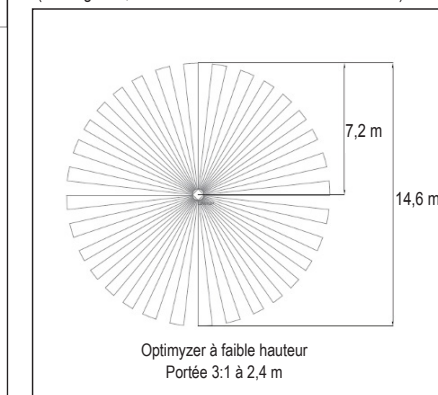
Vue en plongée de la portée de la lentille à 2,4 m
